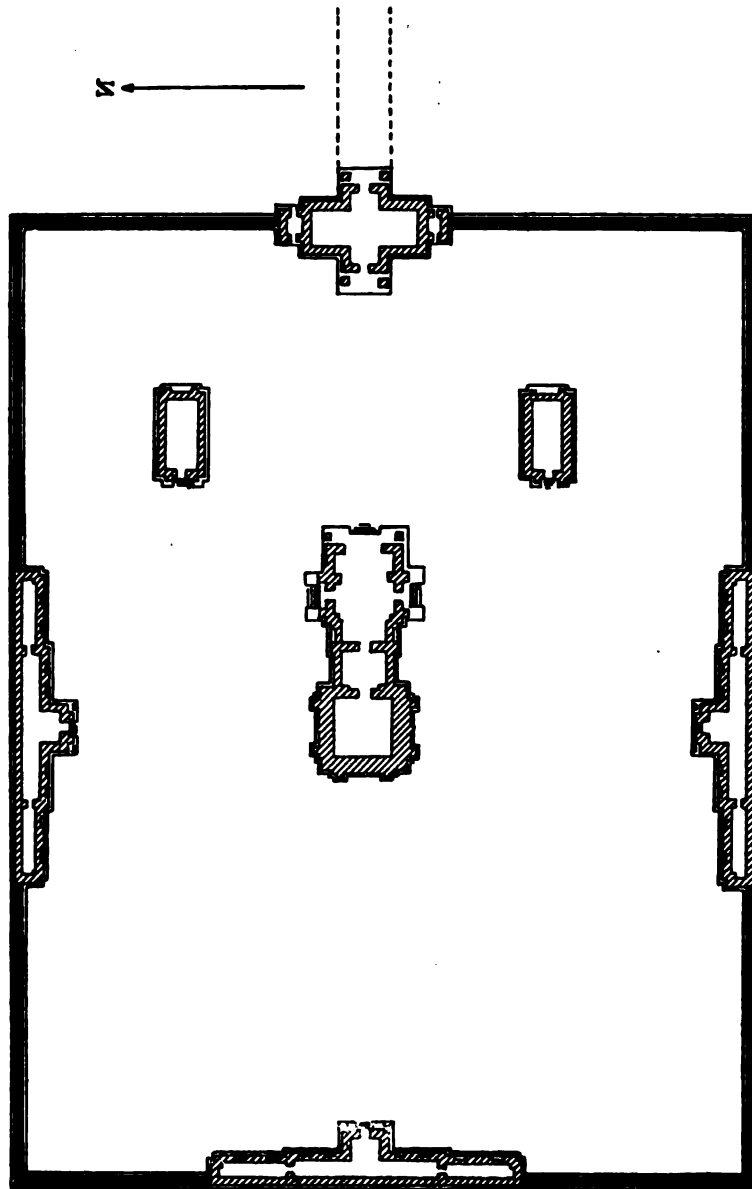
Prasat Khna Sen Keo, n° 261. Plan.
